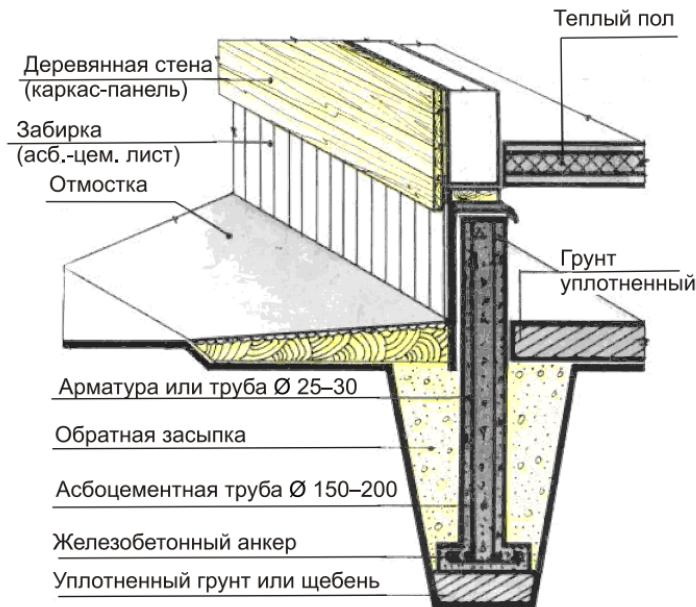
Конструкция фундамента из асбоцементных труб, заполненных бетоном
